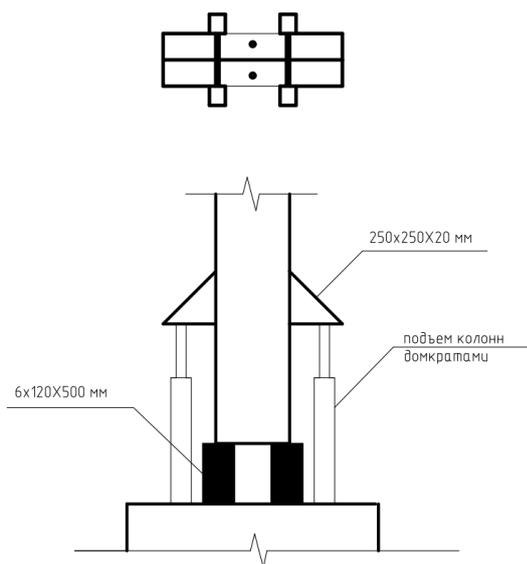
Пример схемы монтажа фасонных элементов на колонны
